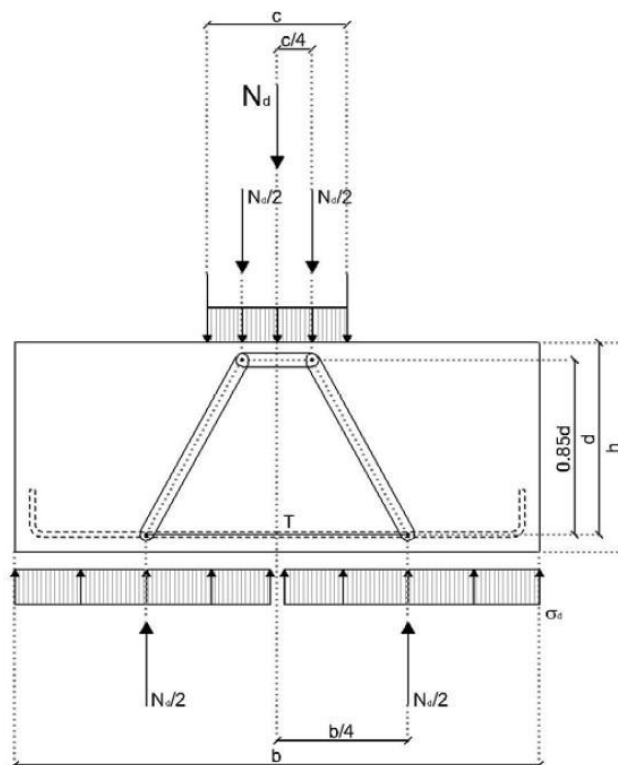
Tipo de tensión y dimensionado de armadura inferior mediante bielas y tirantes
